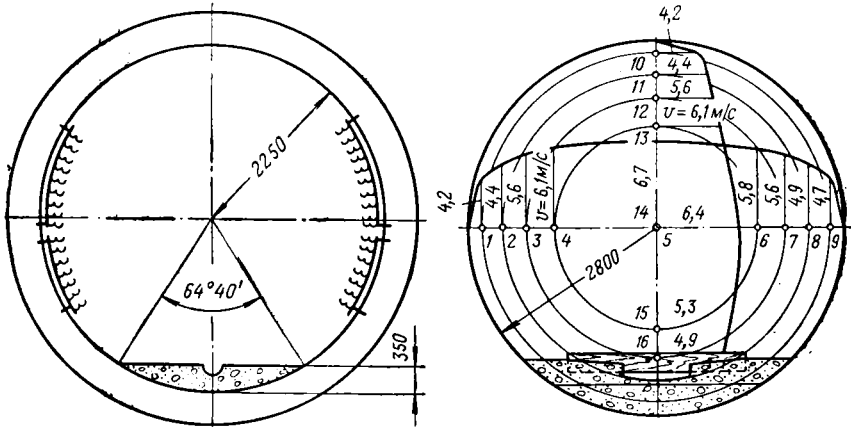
VII. Сечение вентиляционного тоннеля метрополитена внутренним диаметром $d_{вн} = 4,5$ м с обделкой из железобетонных блоков с условно гладкими поверхностями и армировкой
